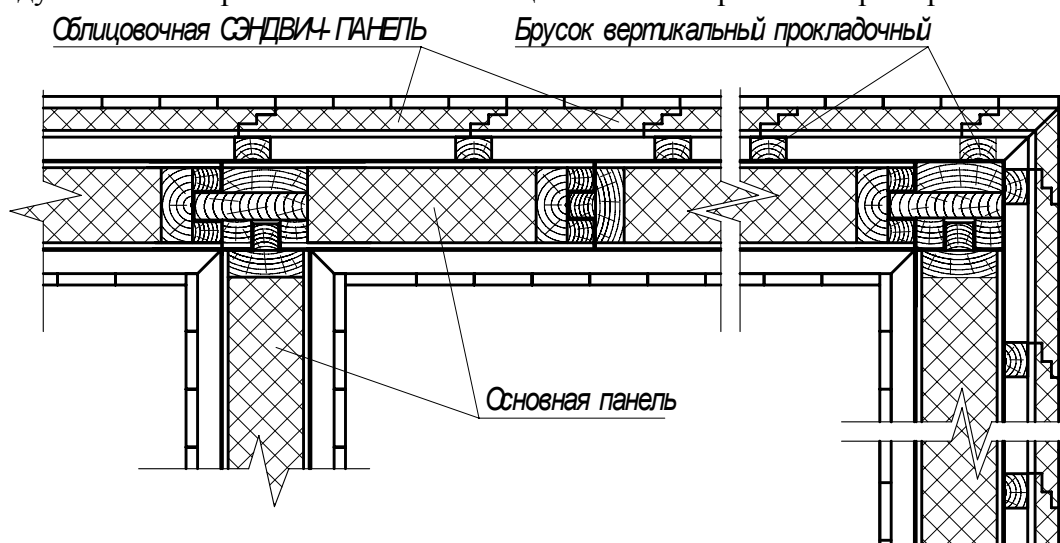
Схема установки и соединения стеновых панельно-каркасных конструкций
